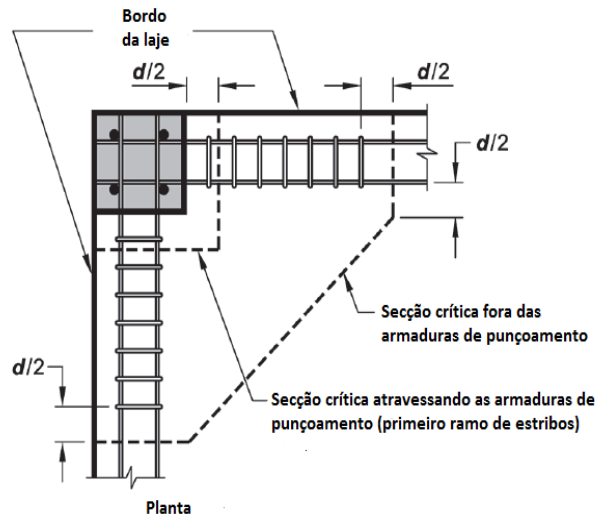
Secções críticas de controlo de punçoamento para pilares de canto com armaduras de punçoamento (Adaptado de ACI 318-14, 2014)
